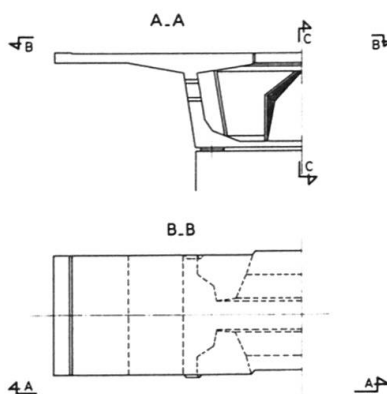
Voussoir sur pile pour tablier de hauteur constante
